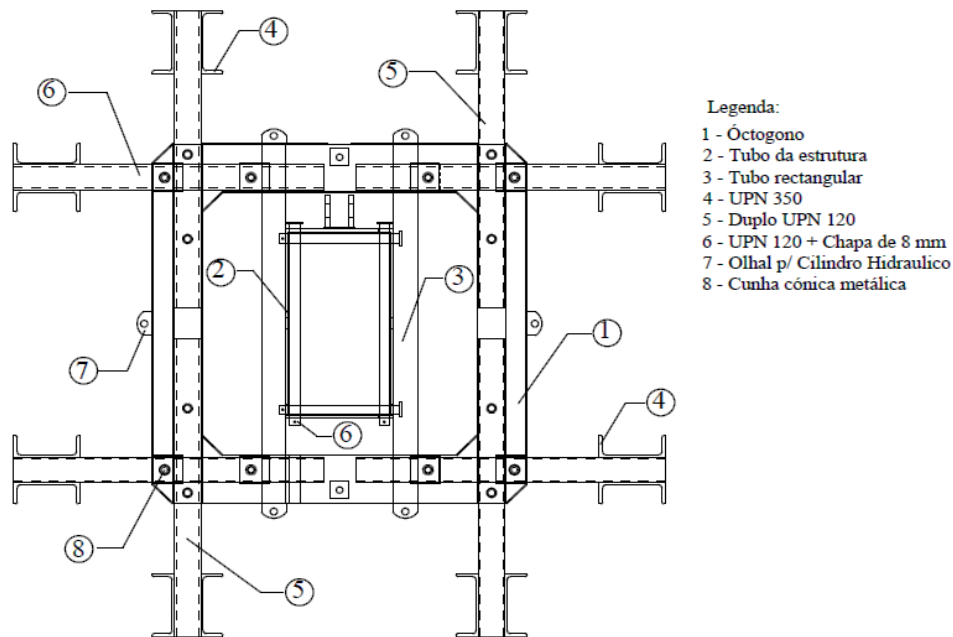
Secção transversal da estrutura de suporte (Fonte: Projeto da cofragem)
